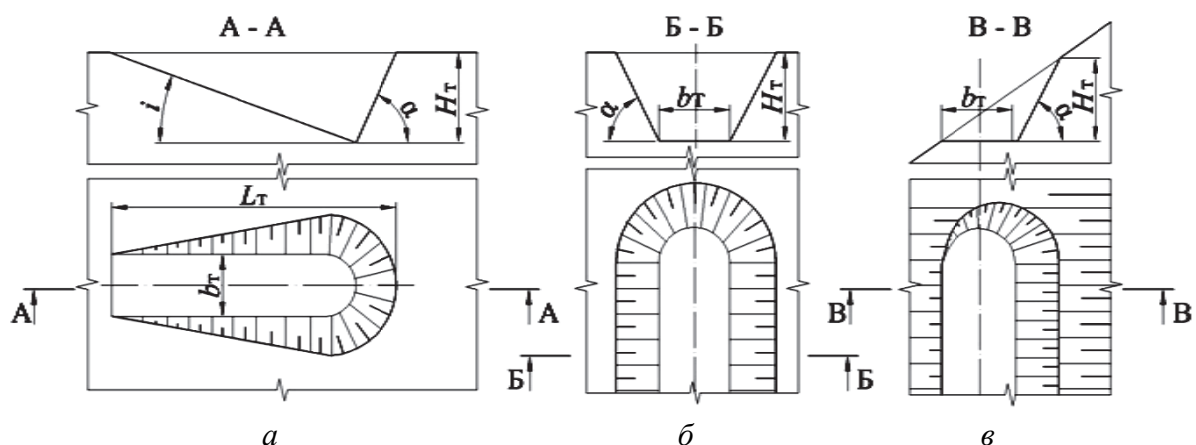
Открытые горные выработки траншеи: а – вскрывающая траншея; б – разрезная траншея; в – разрезная полутраншея; H_t – глубина заложения траншеи; i_p – продольный руководящий уклон; α – углы откоса бортов; b_t – ширина траншеи по нижнему основанию; L_t – длина траншеи в плане
